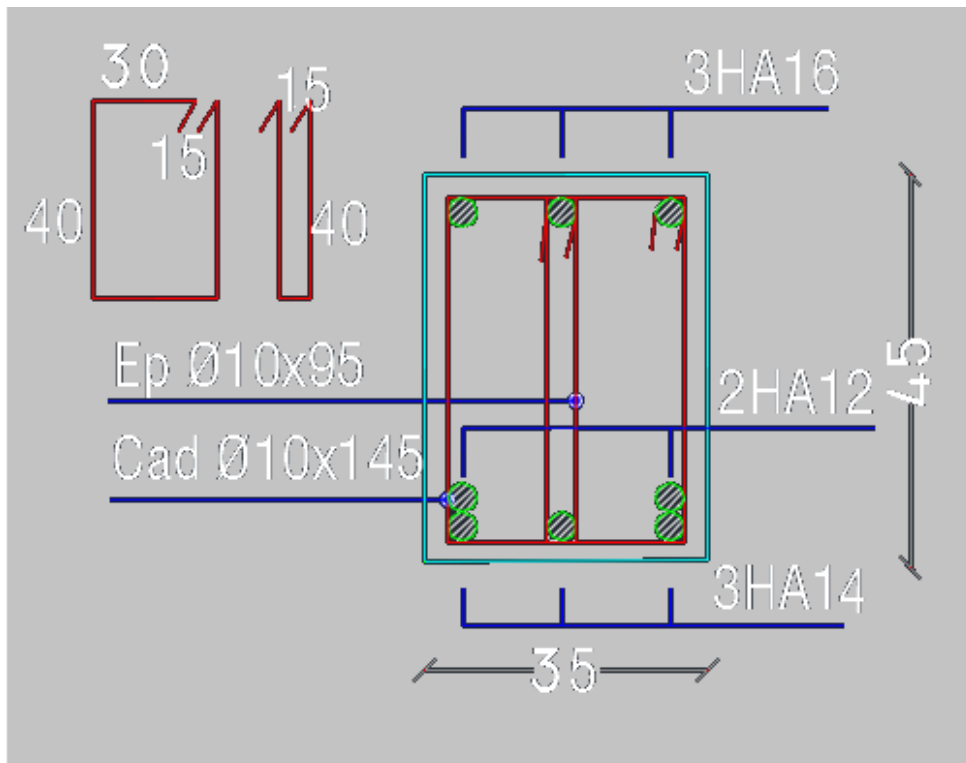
Ferrailage des poutres principales au niveau de travée de RDC et 1<sup>ème</sup> étage.
